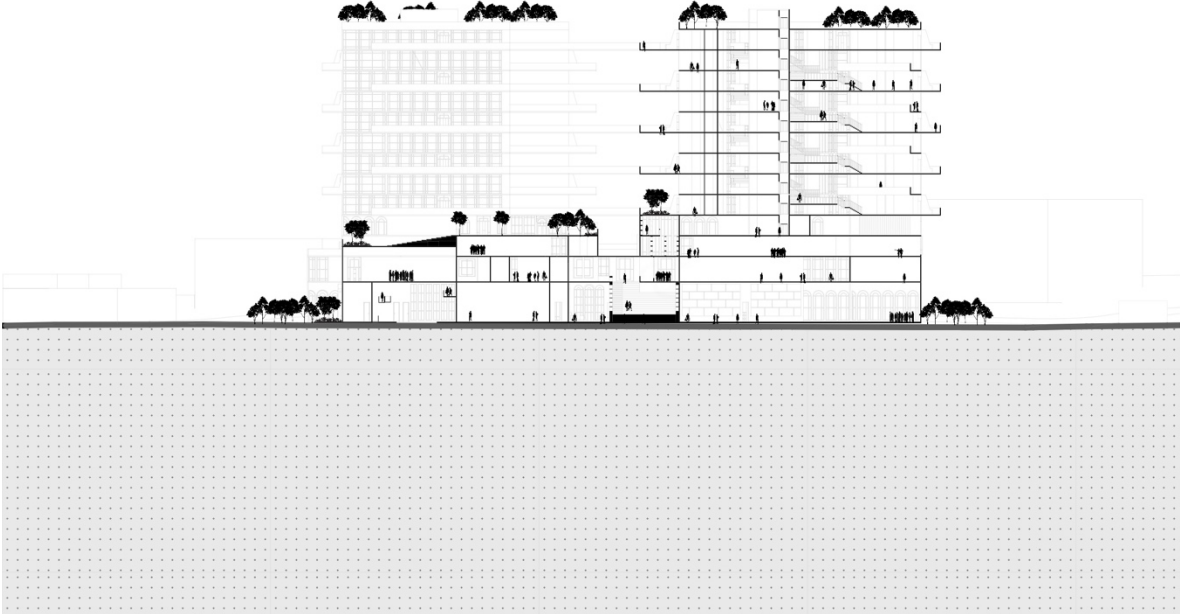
Corte longitudinal C-C'. Elaboración propia.
